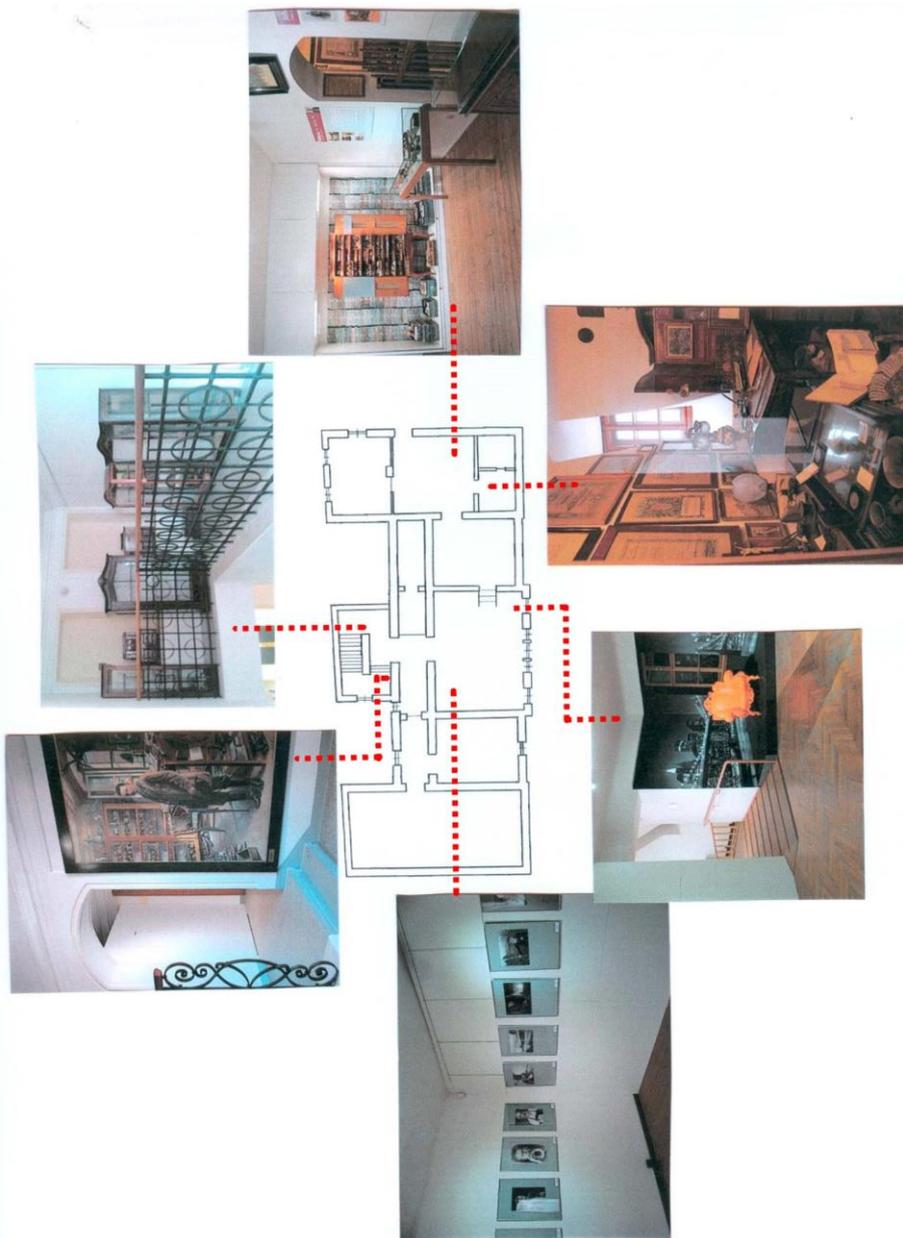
Sonderausstellungsbereich und Depoträume im Dachgeschoß
